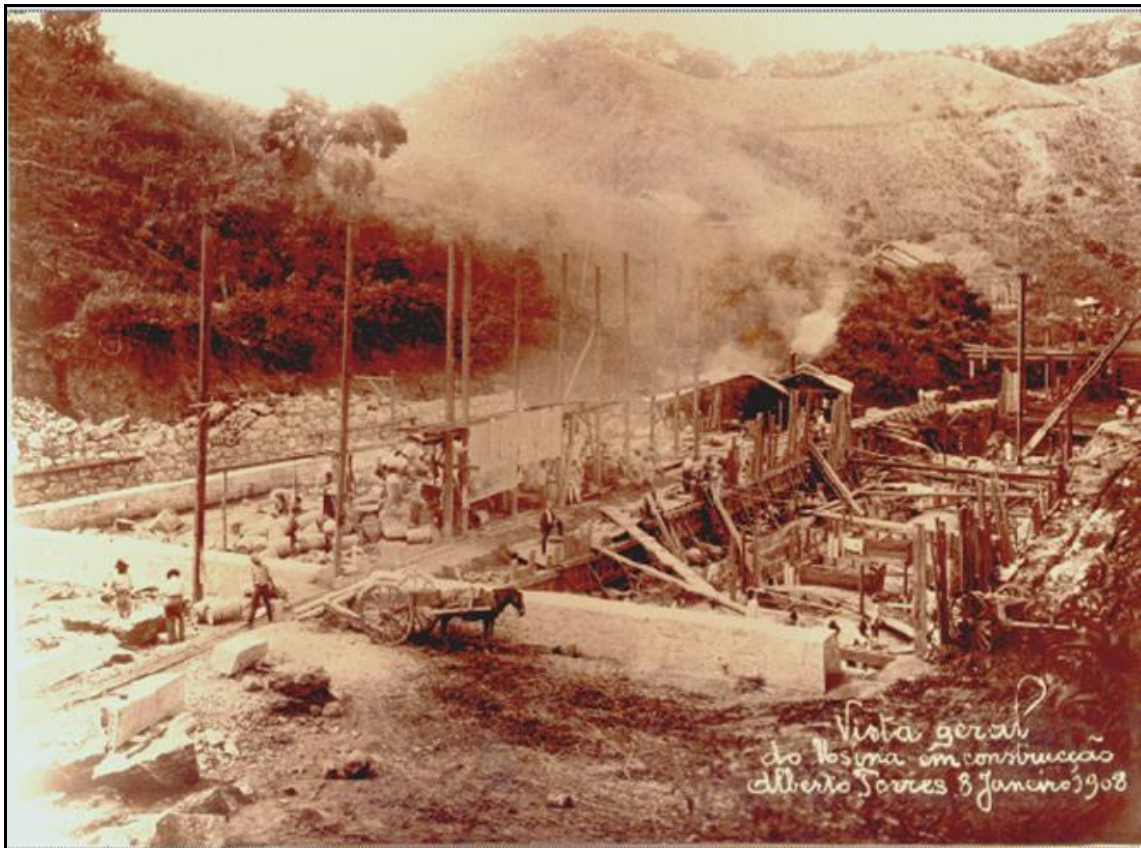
Construção da usina. Fonte: (ME, 2000)
